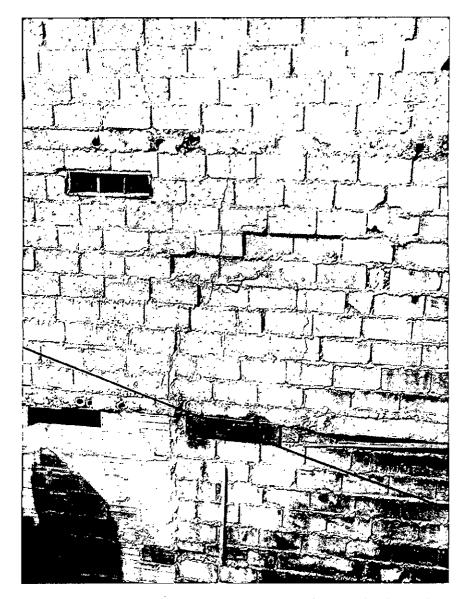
Vista lateral de la vivienda. Grietas verticales y exposición de la madera de entre piso.
